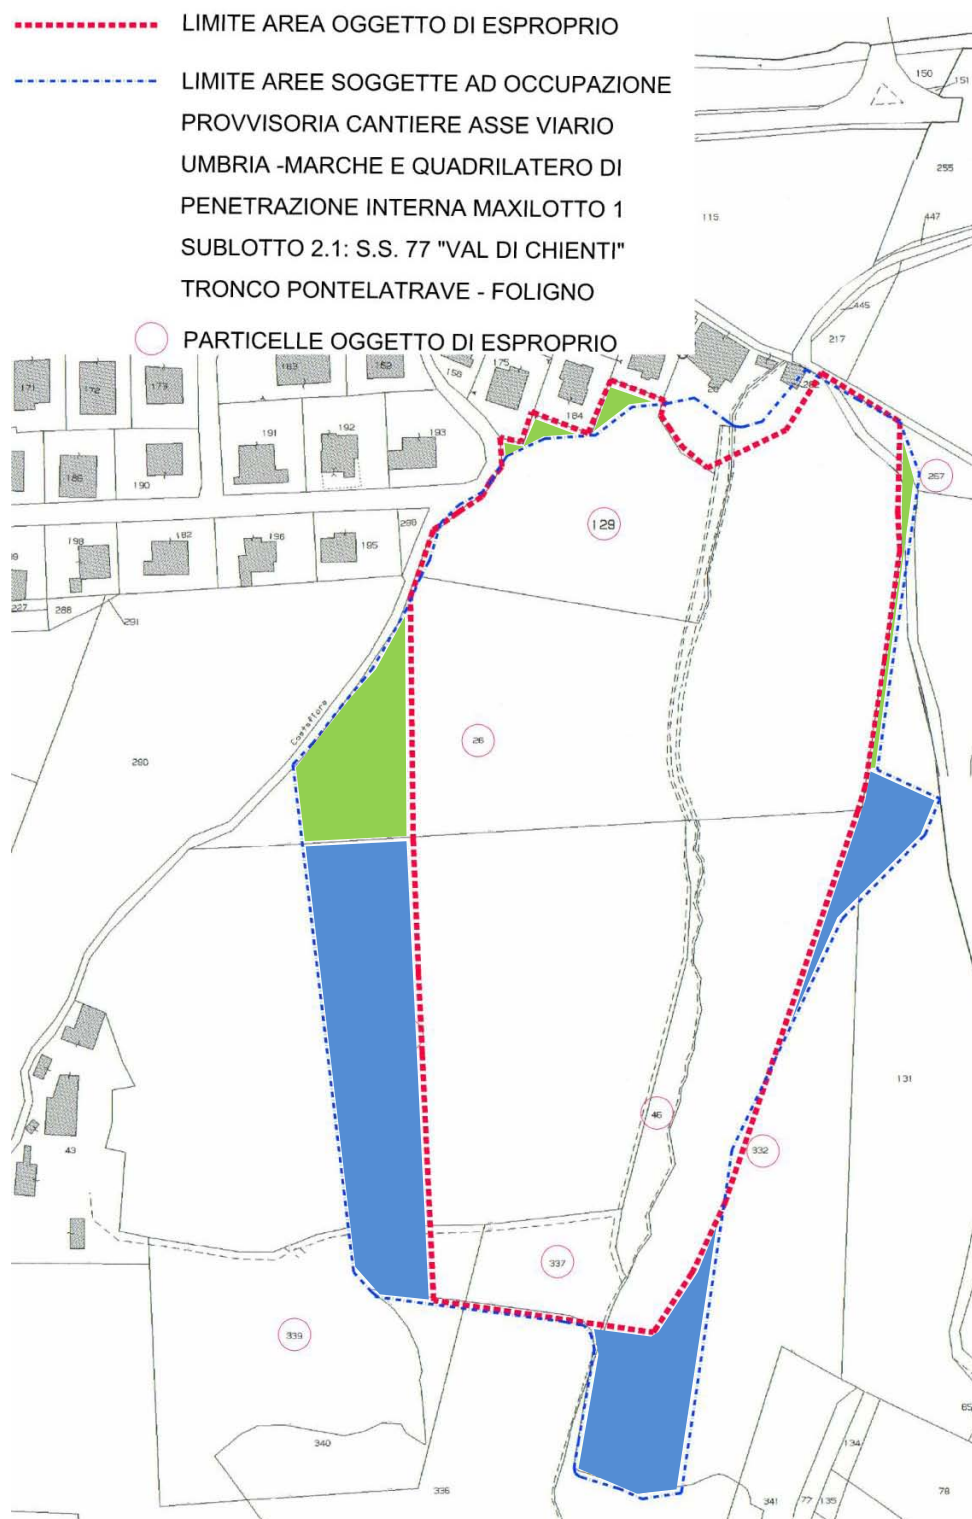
Stralcio planimetrico catastale delle aree oggetto di occupazione temporanea da ripristinare (verde + blu)
